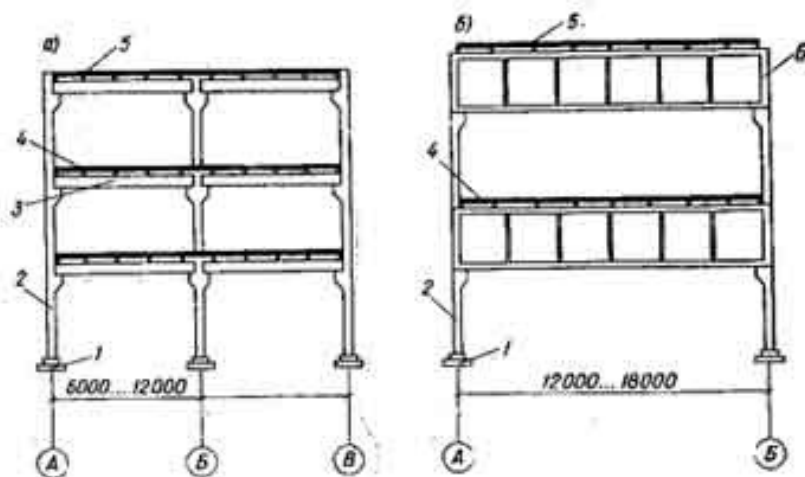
Многоэтажное промышленное здание а - стоечно-балочное; б - большепролетное; 1 - фундаменты; 2 - колонны; 3 - ригели; 4 - плиты перекрытия; 5 - плиты покрытия; 6- безраскосные фермы
